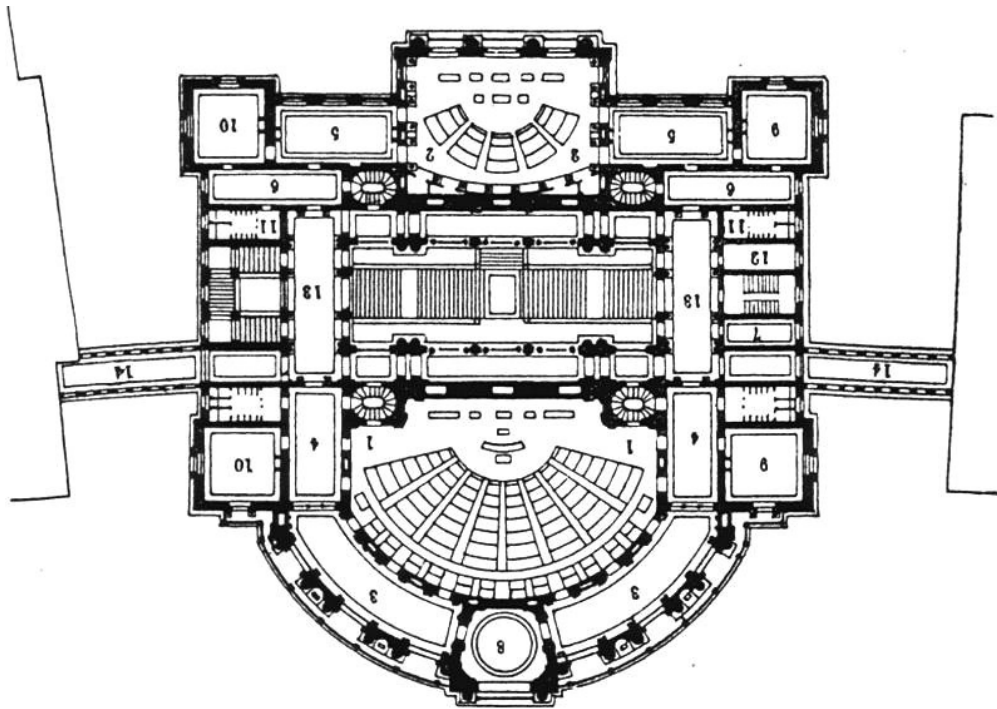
Grundriss Hauptgeschoss, Auer.
